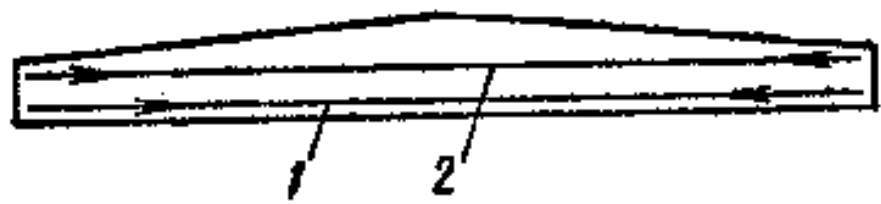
Схема расположения напрягаемой арматуры двухскатной балки:
